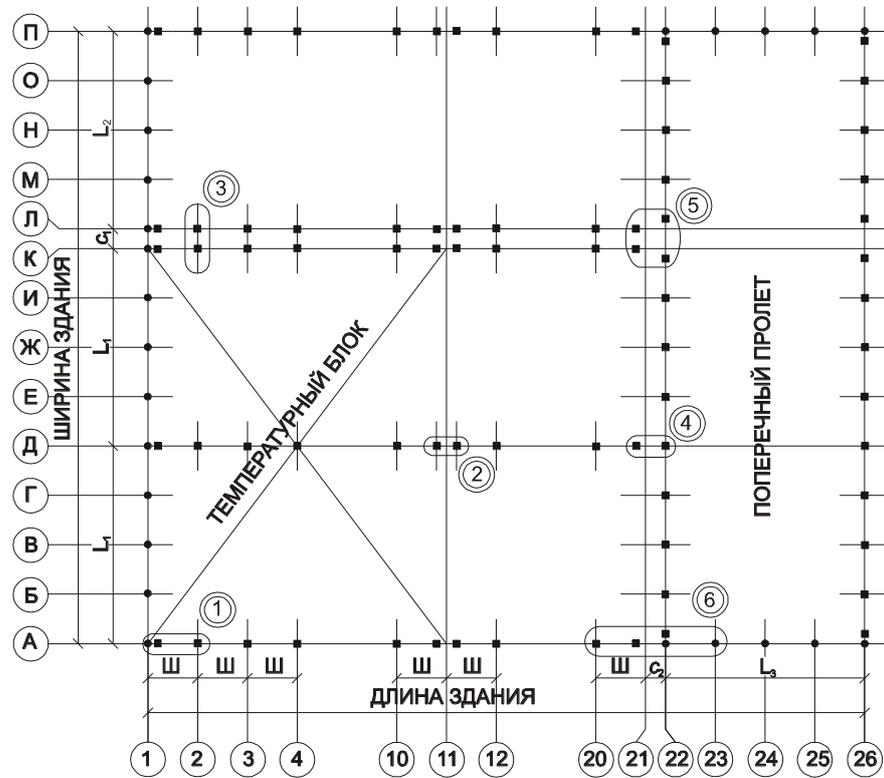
Схематический план (сетка разбивочных осей) одноэтажного промышленного здания с тремя продольными и одним поперечным пролетами
